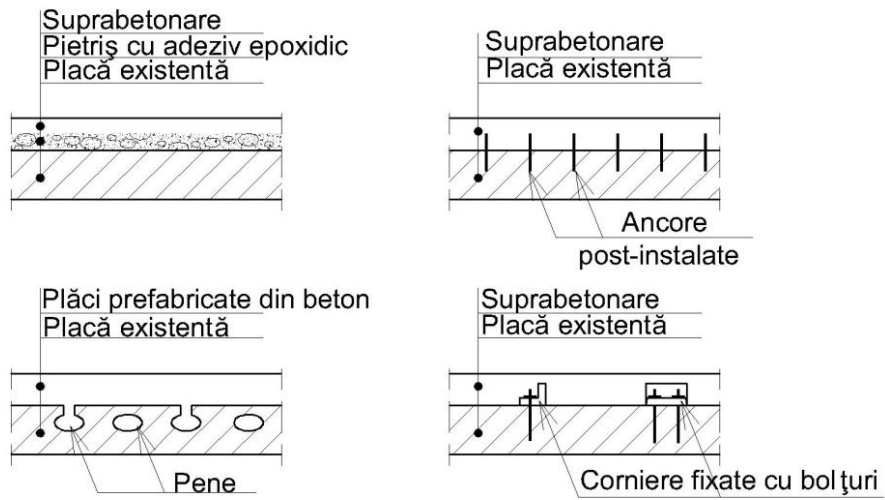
Consolidare plăci din beton armat prin suprabetonare.
